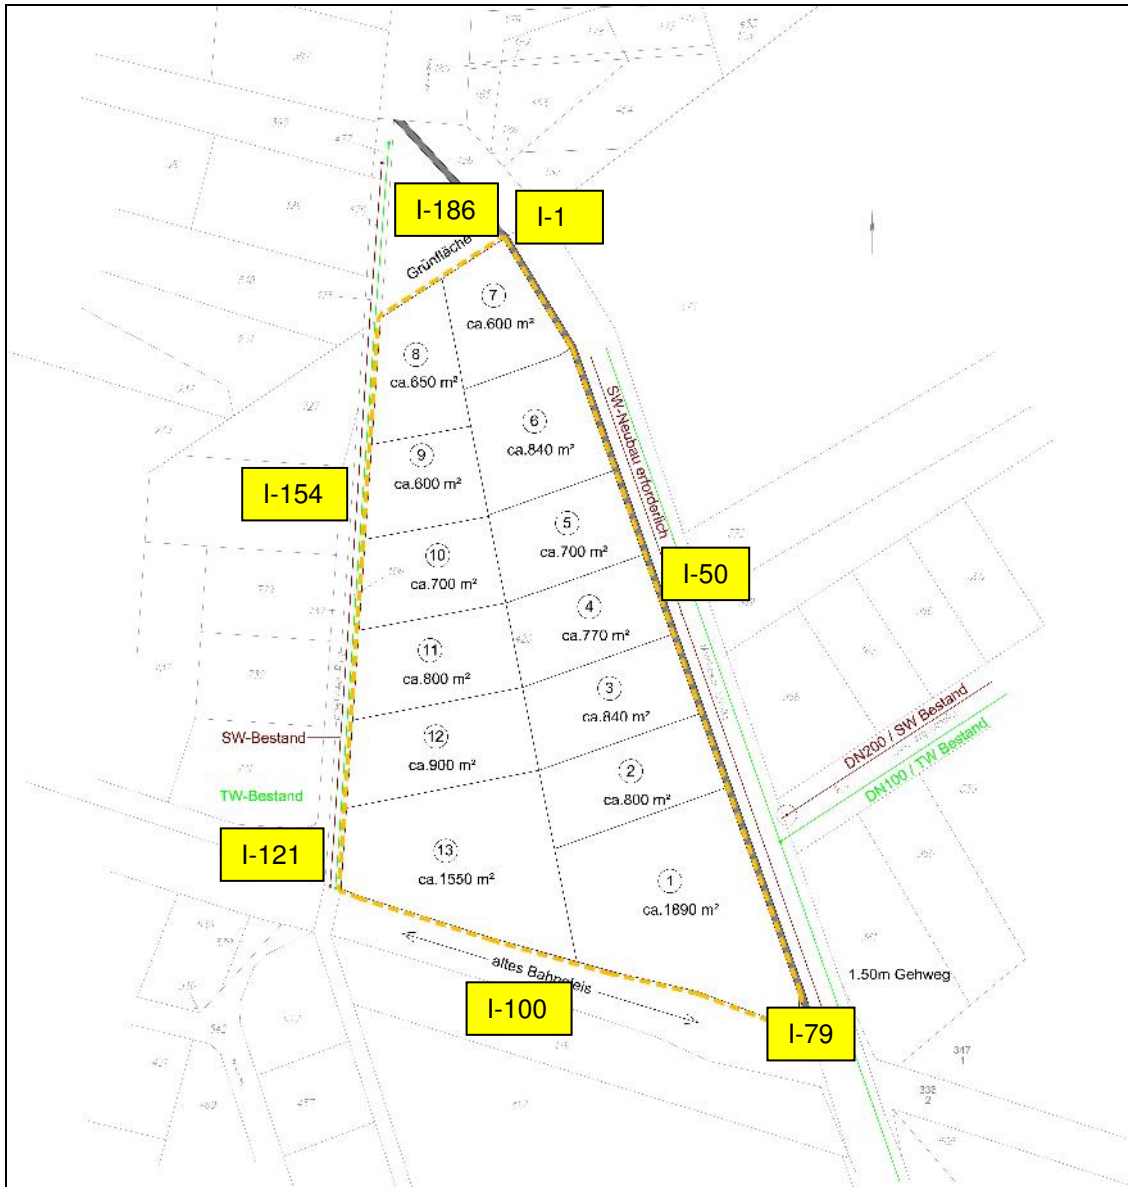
Lageplan mit Darstellung ausgewählter Immissionspunkte (gelb) entlang der B-Plangebietsgrenze, unmaßstäblich
